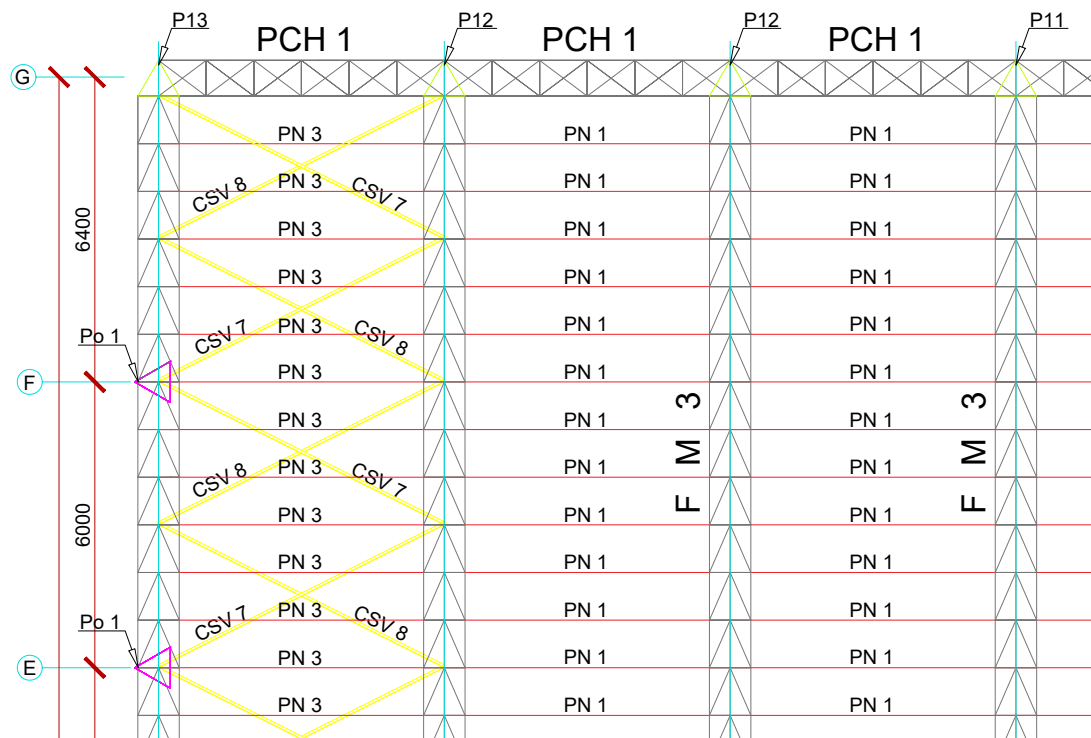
Disposition des pannes au niveau de la toiture.
